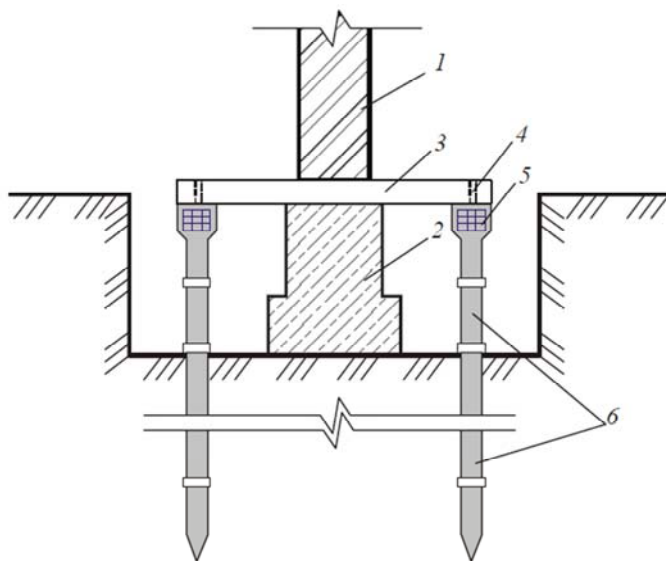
Усиление фундаментов с помощью задавливаемых металлических свай:
